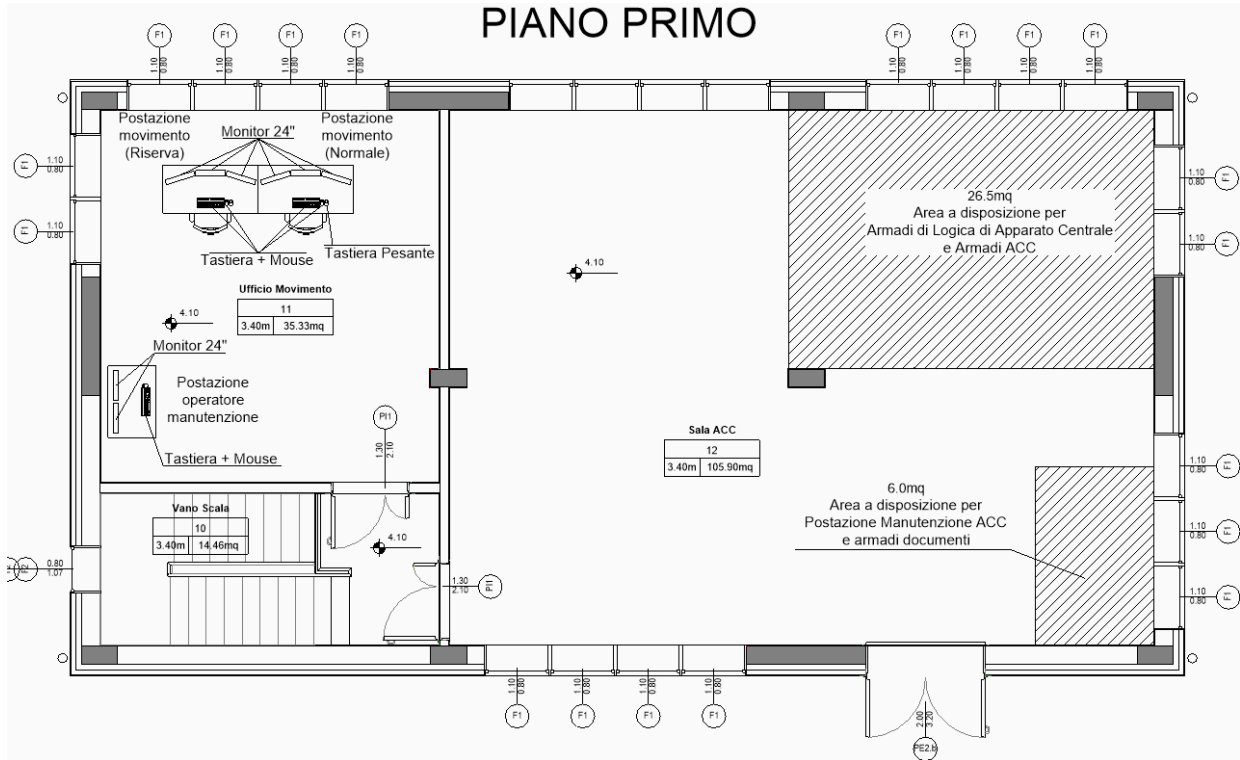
Layout PC/GA1 ACC Bergamo (Ufficio Movimento e Sala ACC)
